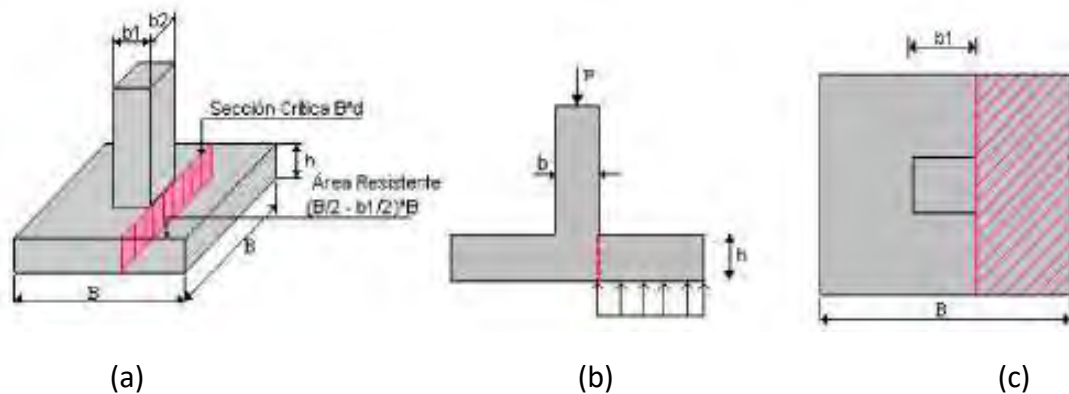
Cortante unidireccional en zapatas aisladas, (a) vista en 3d de la sección crítica, (b) vista en perfil, (c) vista en planta
